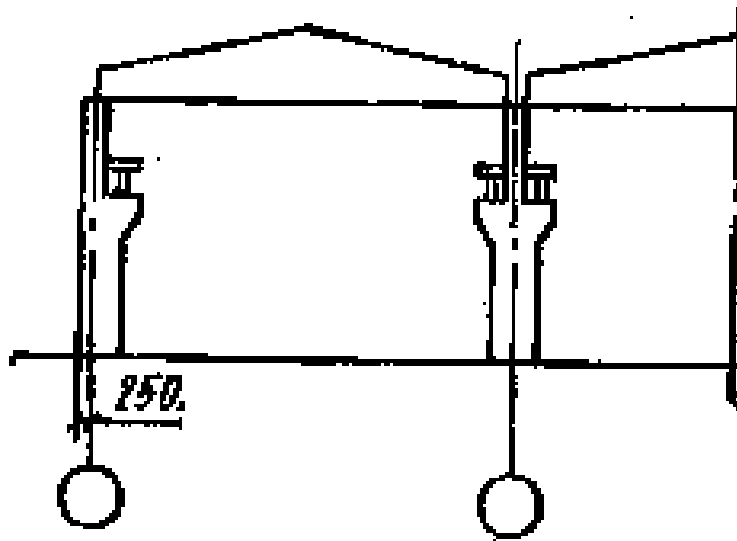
Привязка элементов конструкций к разбивочным осям на поперечном разрезе
